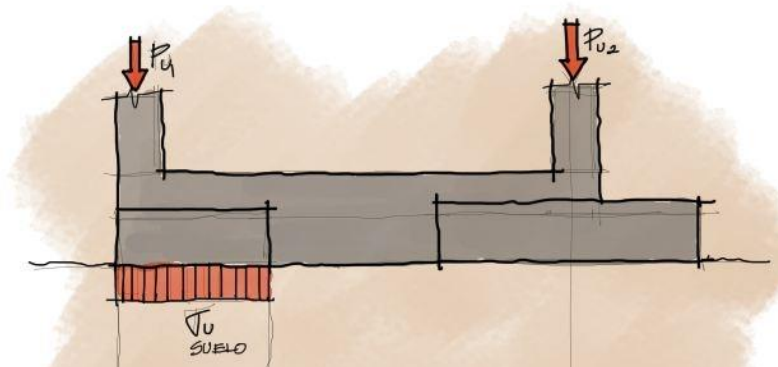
Distribución de esfuerzos debajo de zapata excéntrica con viga de equilibrio
